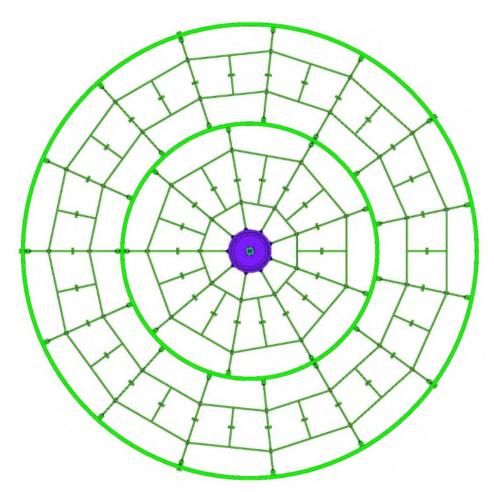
Собранный обкатной контур в сборе с центром. Вид в плане
